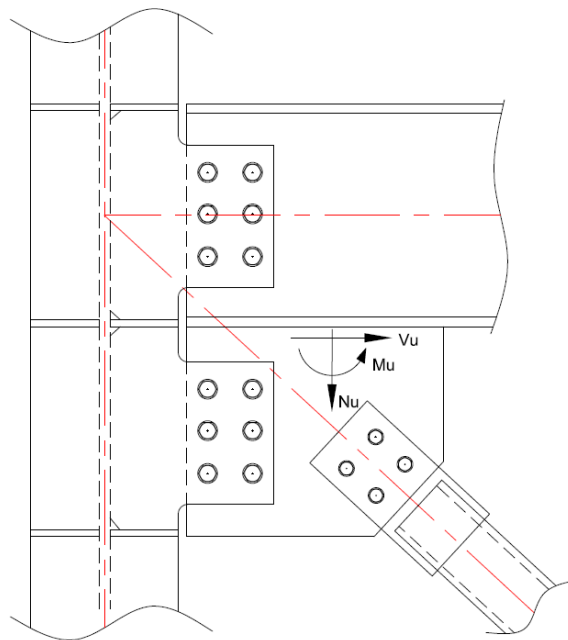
Fuerzas en lado de cartela soldada
